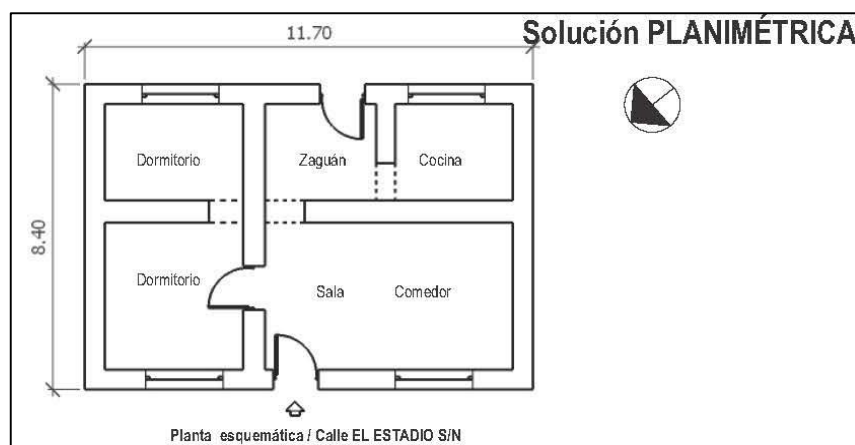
Planta rectangular con sala-comedor en la primera crujía
